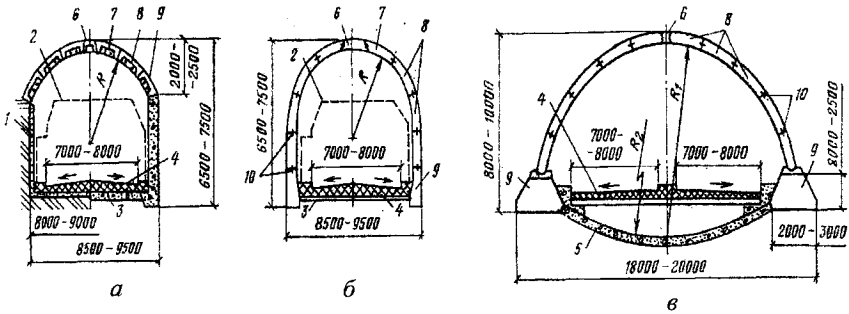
Конструкції збірних кріплень склепінного окреслення:
